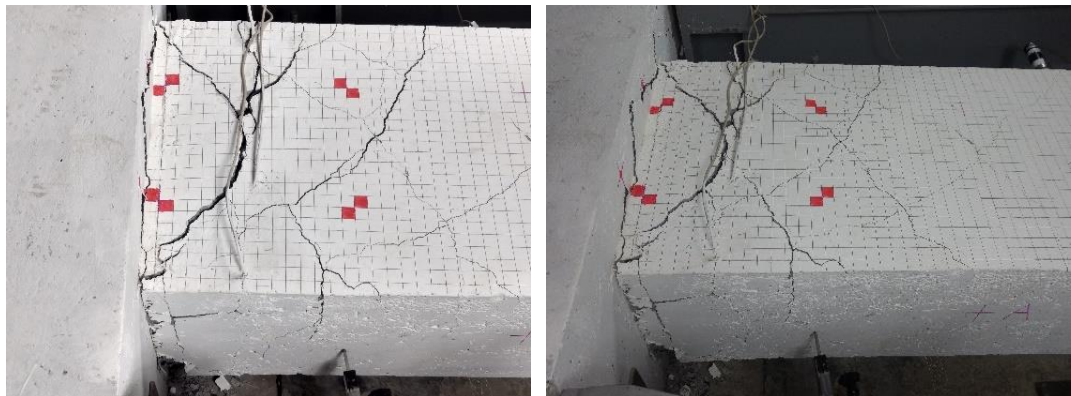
Patrones de grietas al término de la prueba del espécimen ($E - 1$).
